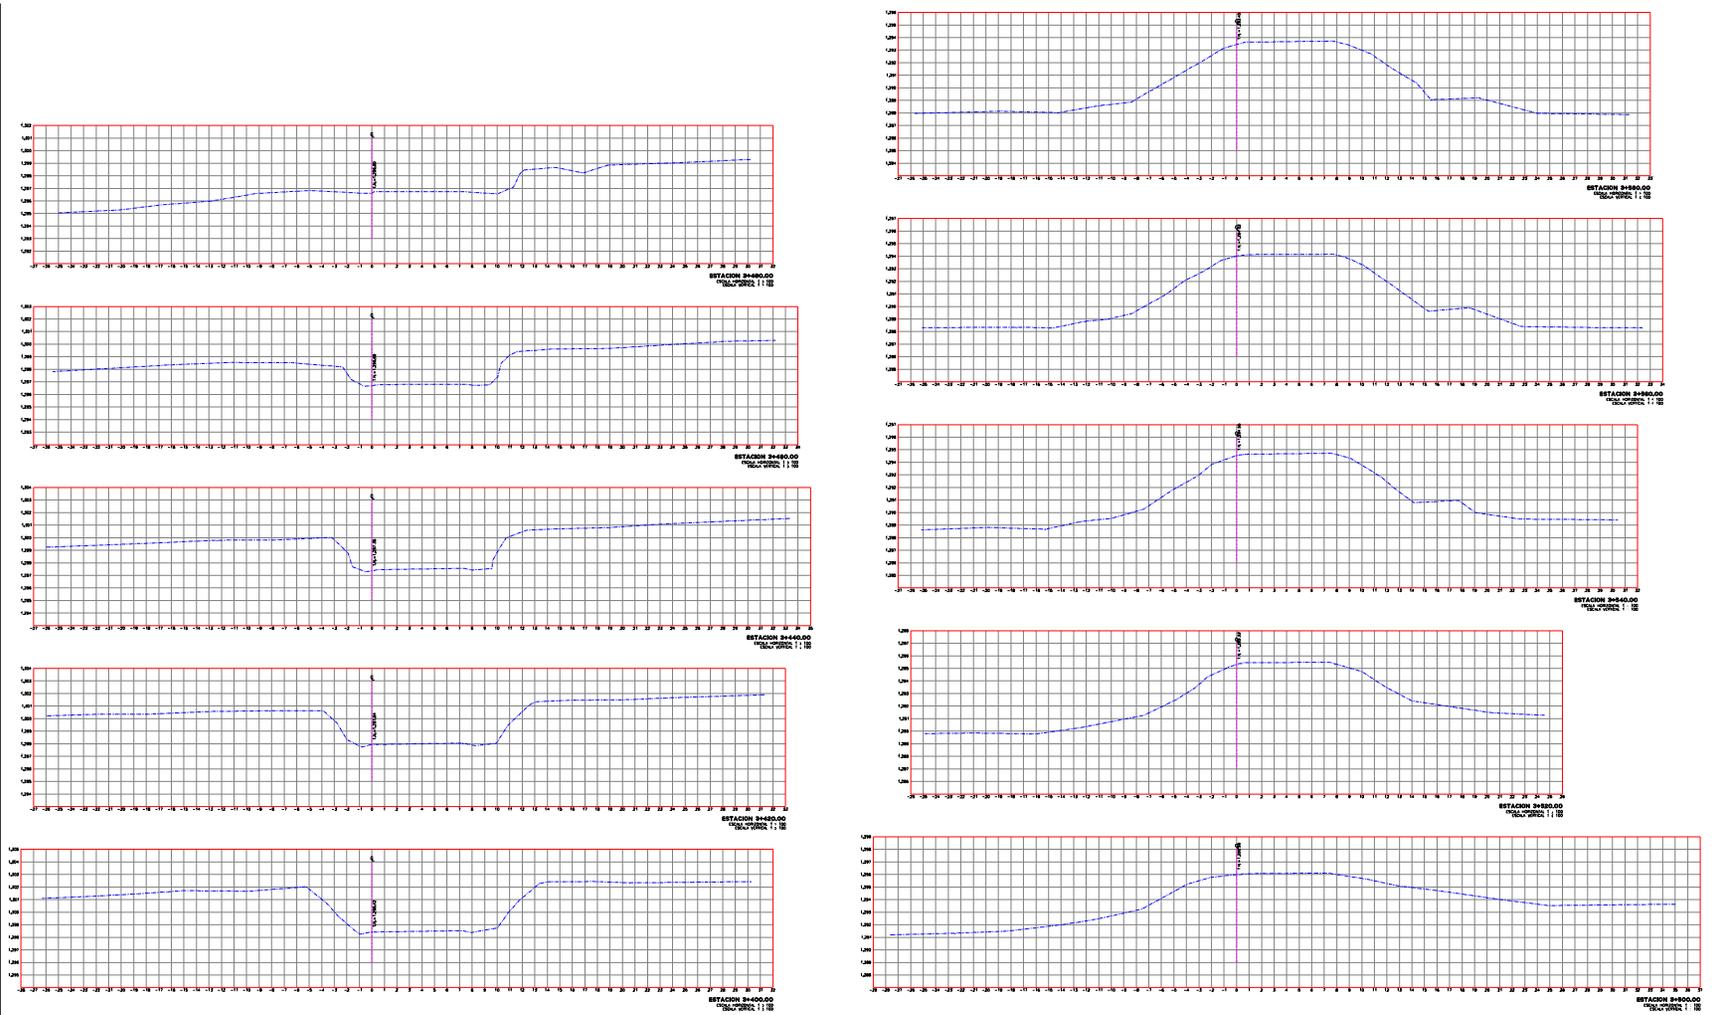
Parte del plano de las secciones transversales de terreno natural levantadas y dibujadas de la estación 3+420 a la 3+580
